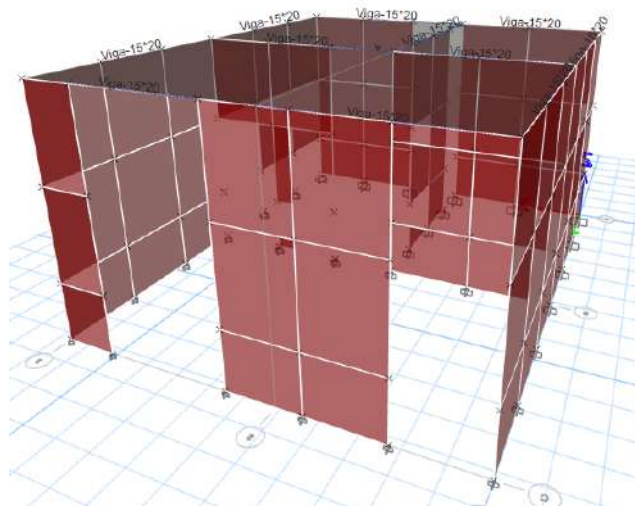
Vista en planta del modelamiento de la vivienda 07
